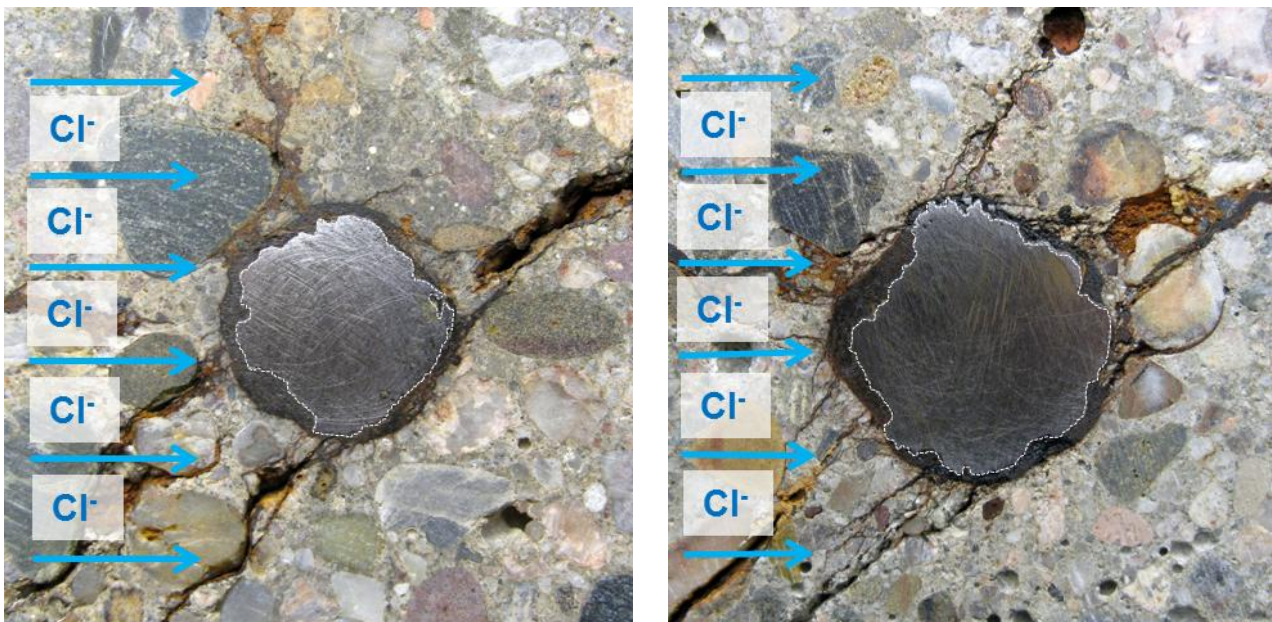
Dünnschliff senkrecht zur Ausziehrichtung mit in die Porenstruktur des Betons eingedrungenen Korrosionsprodukten im Rissbereich
